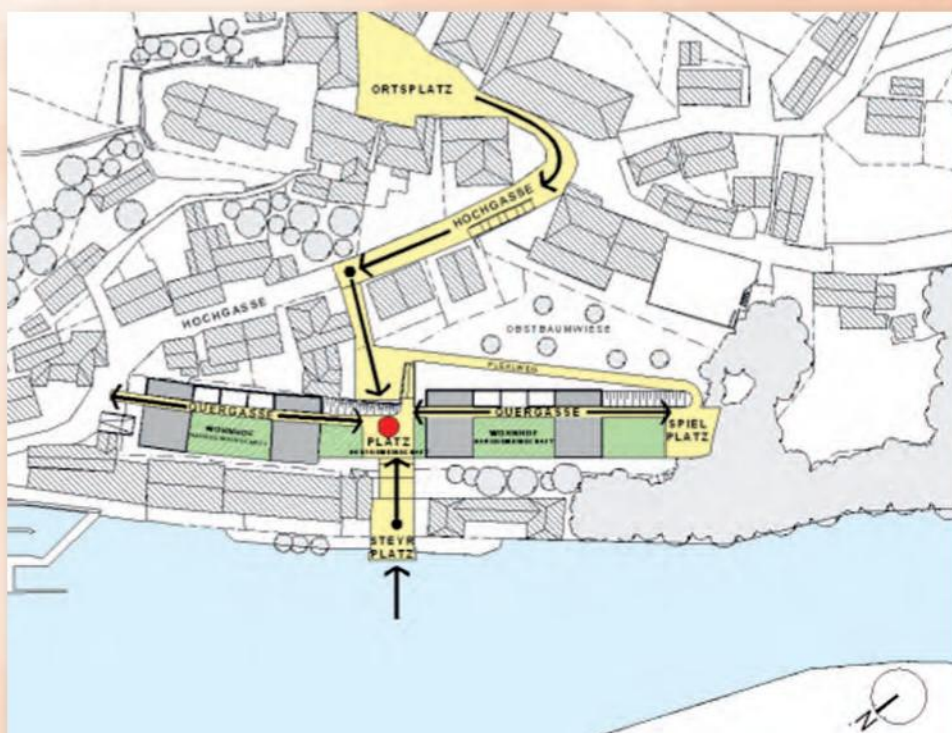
Grundriss Lageplan zum Realisierungsprojekt "Die drei Höfe" in Steinbach an der Steyr, (Quelle: Arch. DI.- Inge Hinterwirth)
